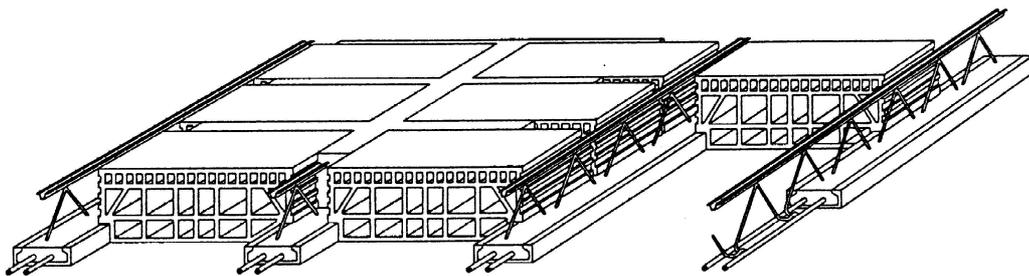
Stahlbetonrippendecke, statisch mitwirkende Zwischenbauteile
